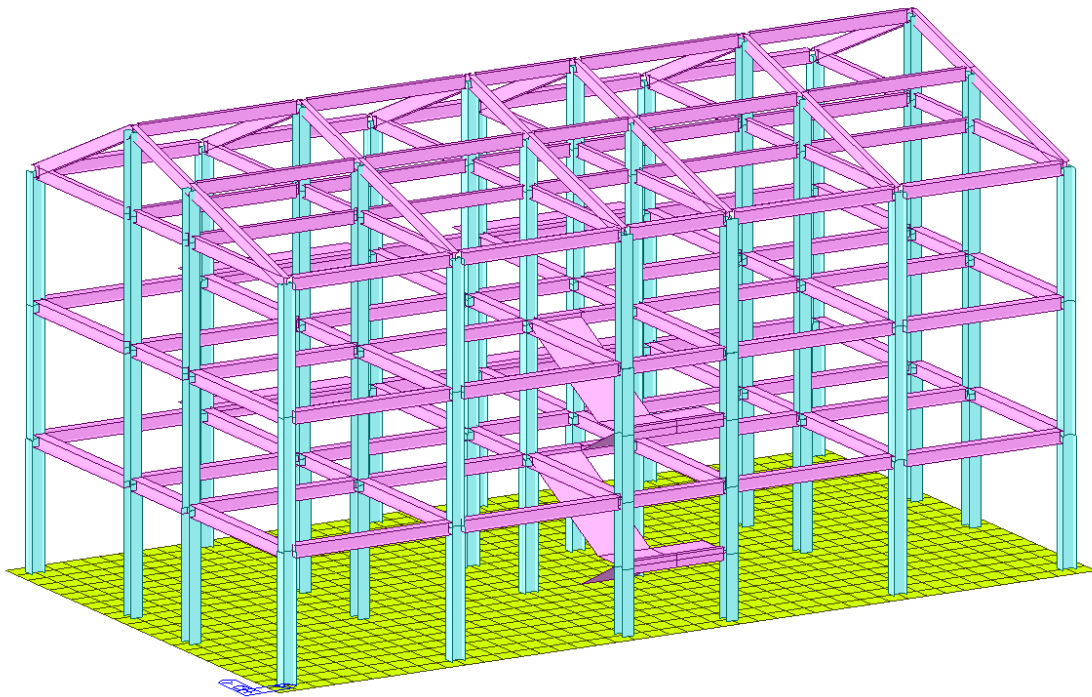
Modello FEM edificio a tre piani in acciaio con platea di fondazione - Vista assometrica 1.
